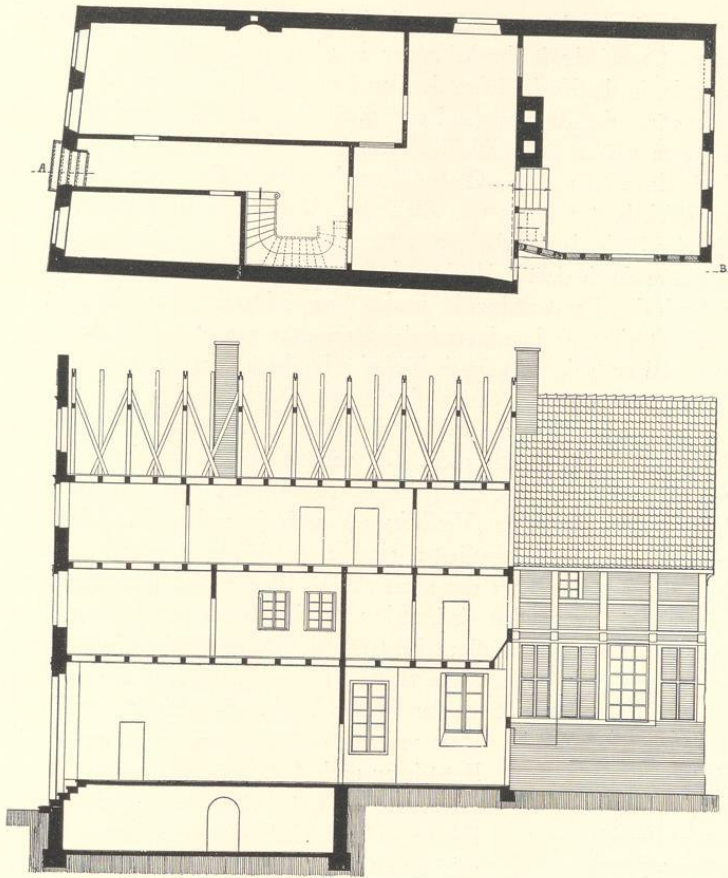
und 875. Grundriß und Längsschnitt des Hauses Alter Fischmarkt 19/20
